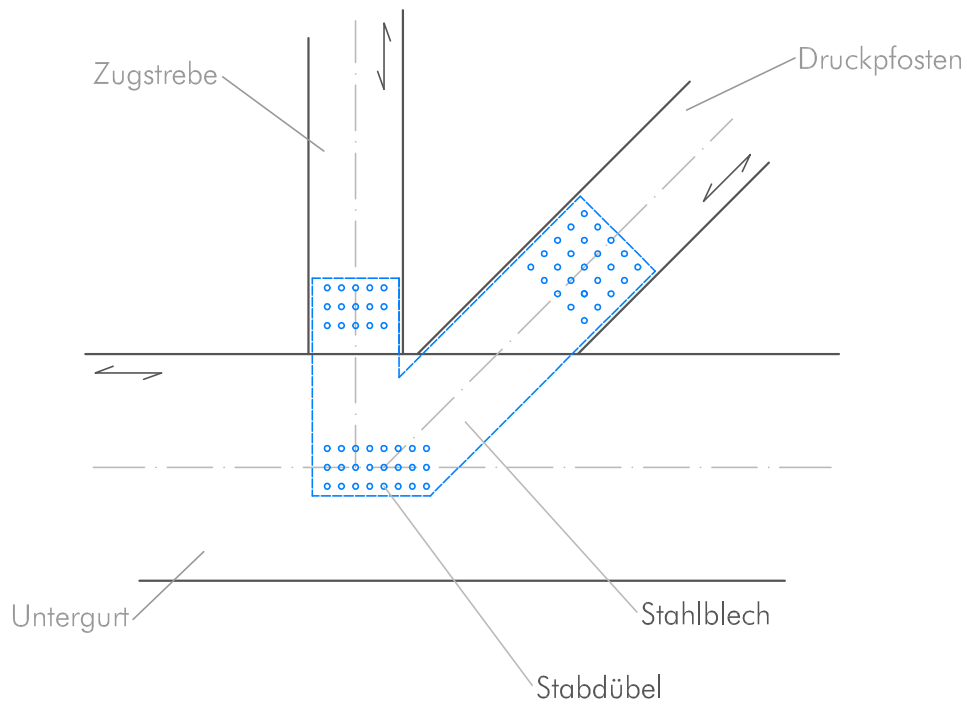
Anschlusslösung für Fachwerkknoten mit Stabdübeln und eingeschlitzten Stahlblechen
